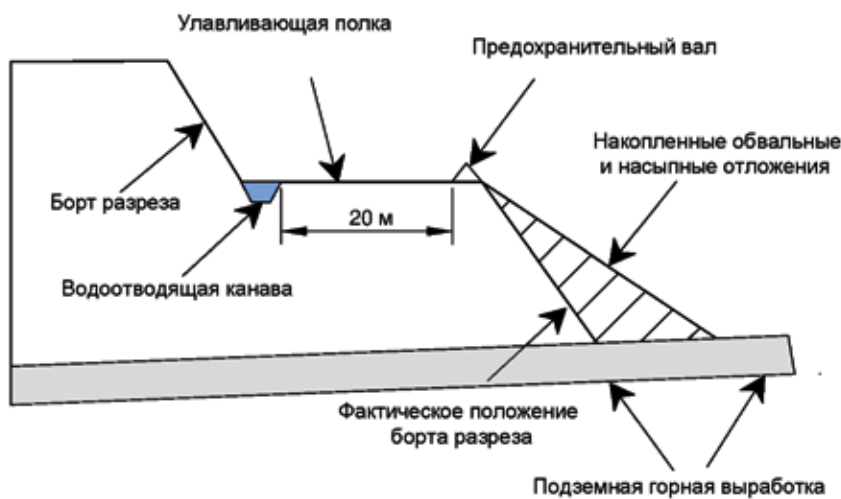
Схема профиля борта разреза с улавливающей полкой
